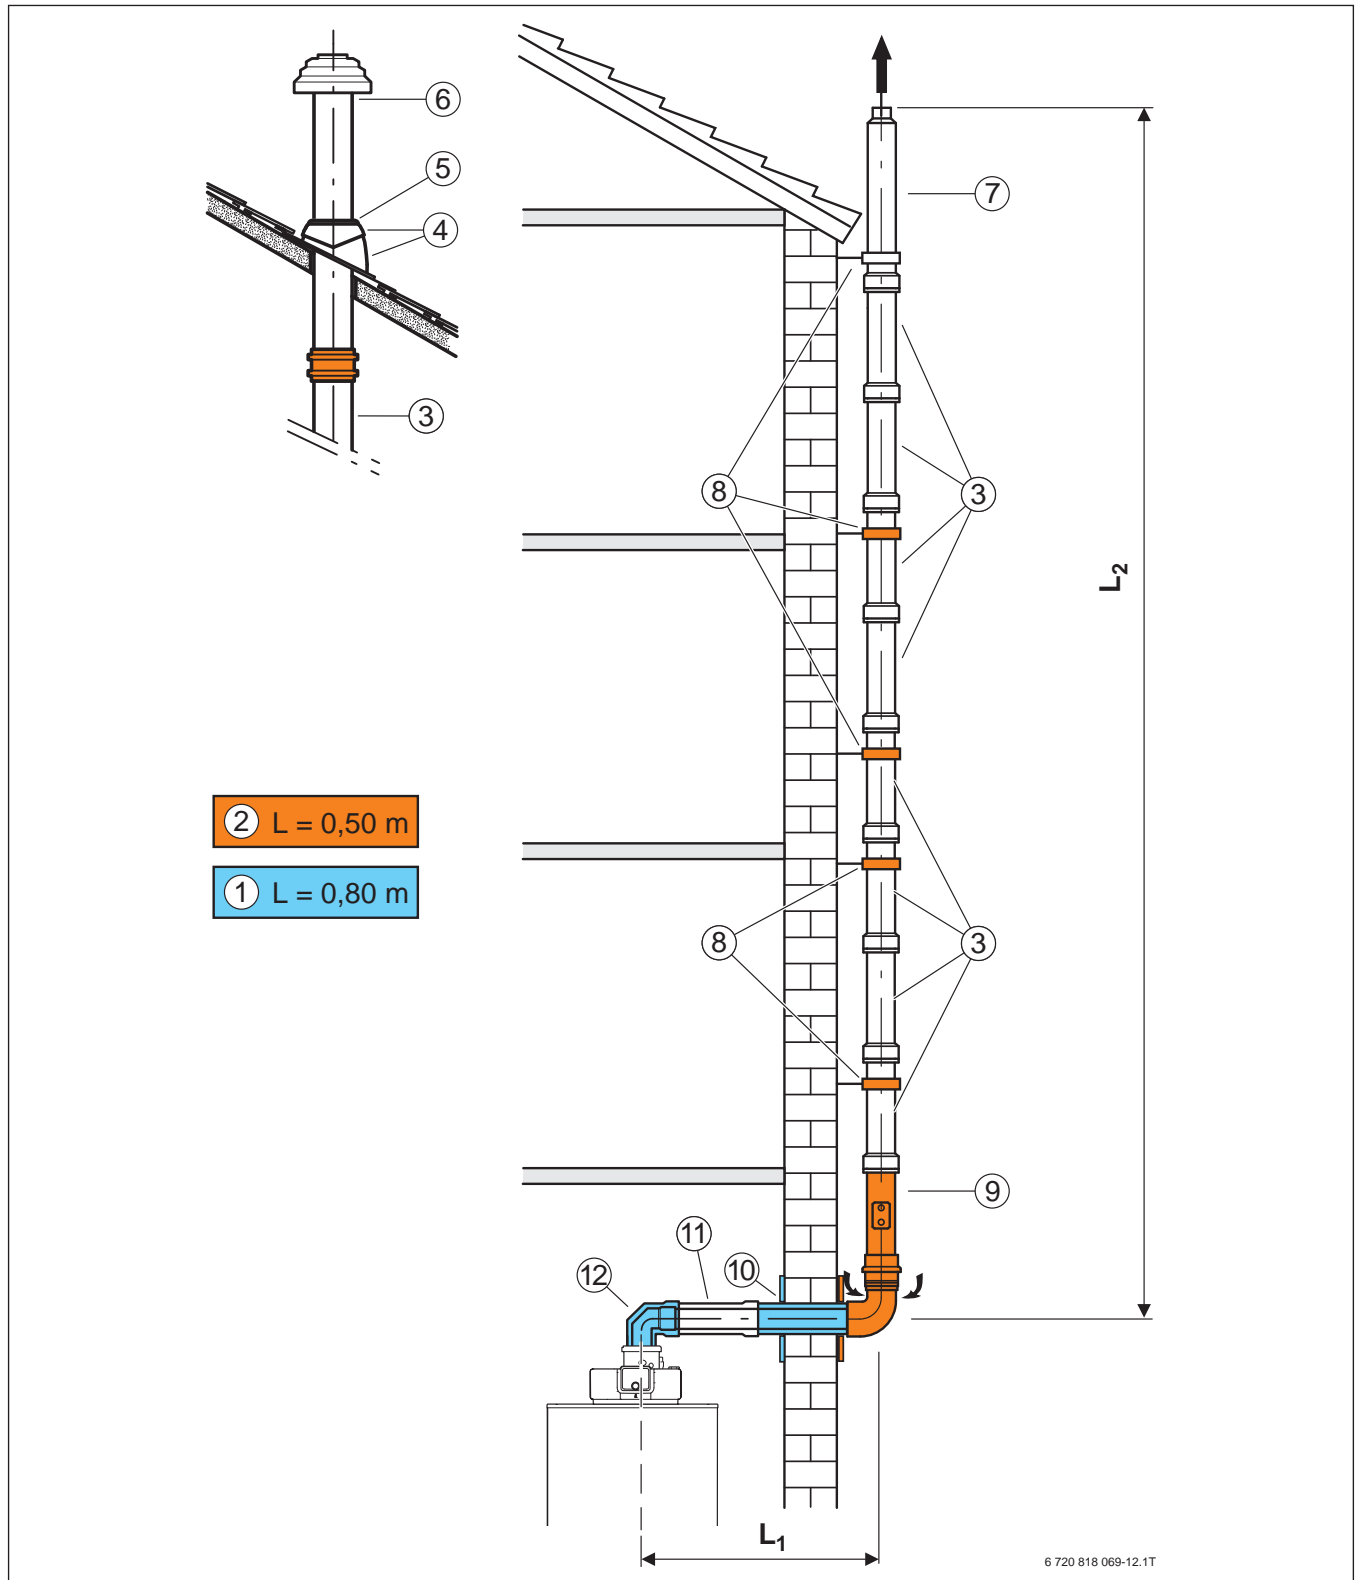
Abgasführung über Abgasleitung Ø 80/125 mm an der Fassade (C<sub>53x</sub>)
